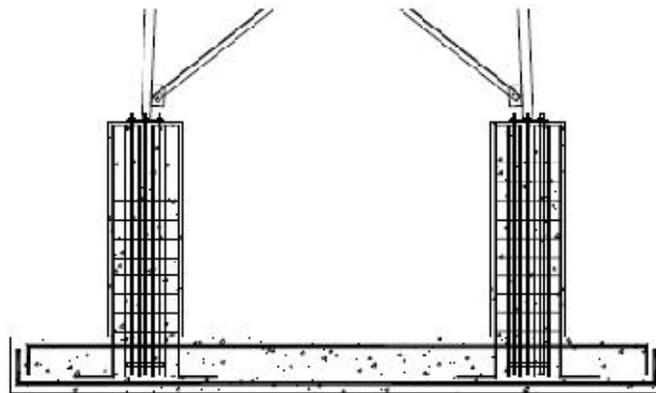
LOSA DE CONCRETO ARMADO
